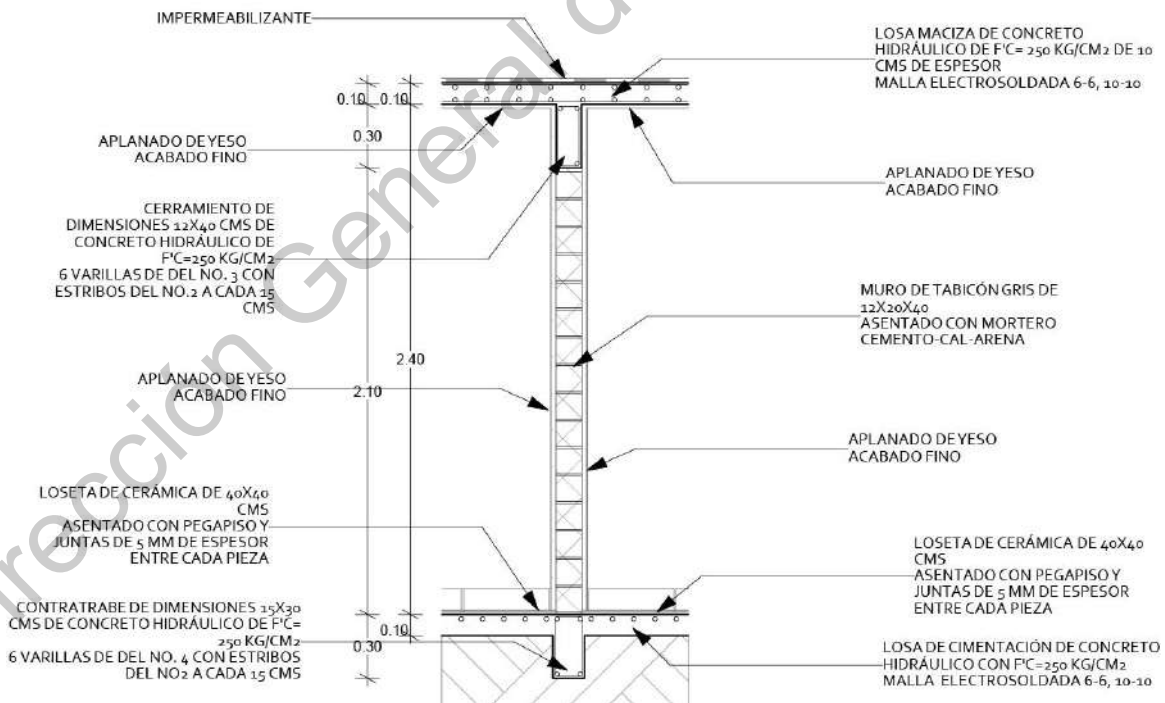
Corte por fachada de muro interior. Elaboración propia.
